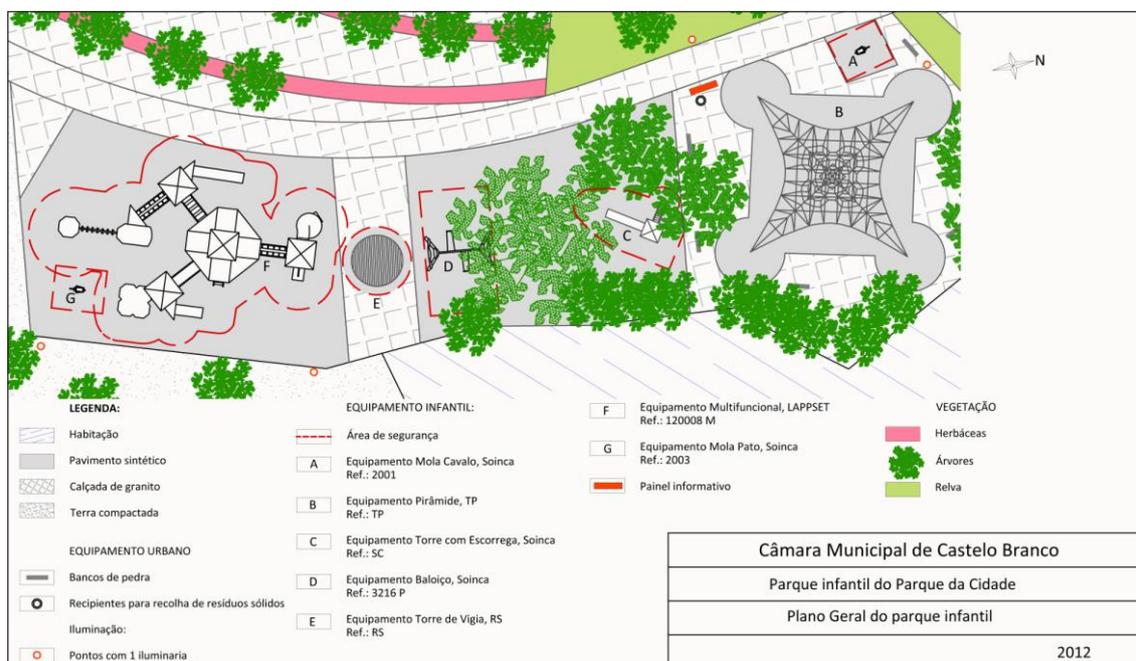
Planta do parque infantil do Parque da Cidade. (Planta elaborada pela autora)
